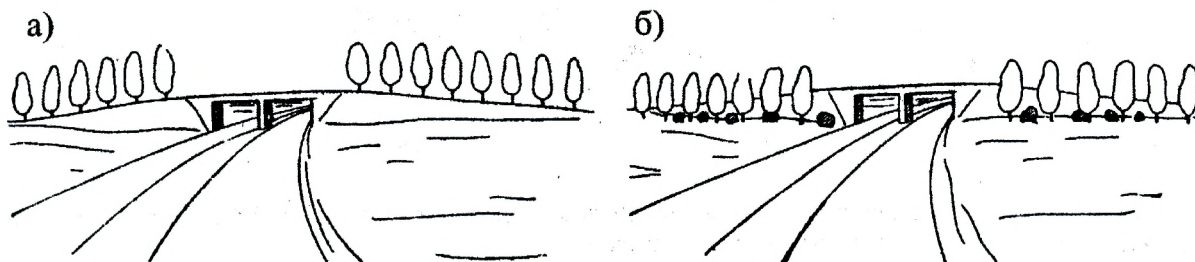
Маскировка некрасивой насыпи на подходах к пересечению в разных уровнях: а – посадка деревьев на насыпи зрительно увеличивает ее высоту и делает ее еще более бросающейся в глаза и некрасивой; б – маскировка высокой насыпи посадкой высоких деревьев у ее подошвы
